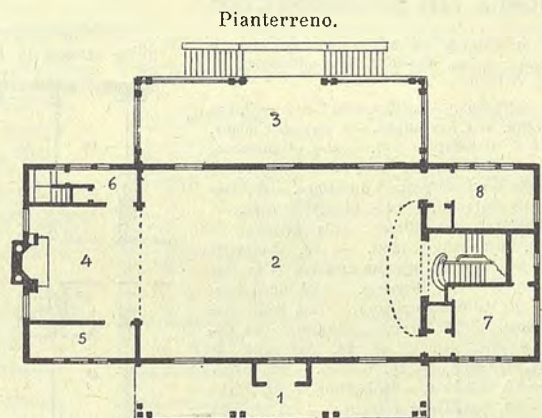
a. — Club Riverdale a New-York City (arch. Dwight J. Baum).
